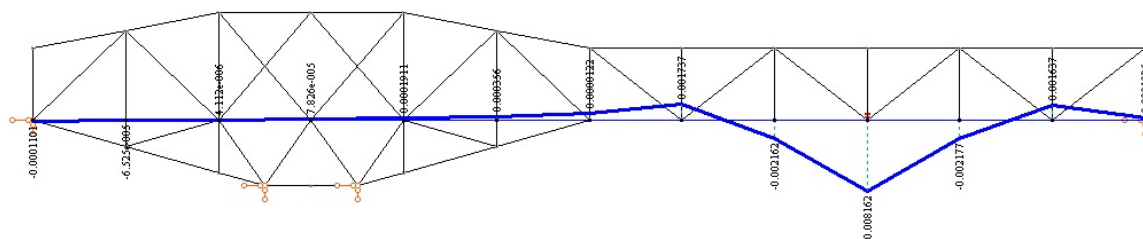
л.в. поздовжня сила варіант №3 елемент ферми В9-Н9
